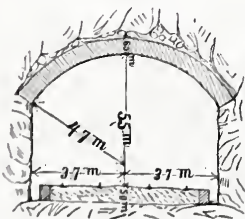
Profil einer nicht ausgemauerten Strecke des Kanal-Tunnels.
